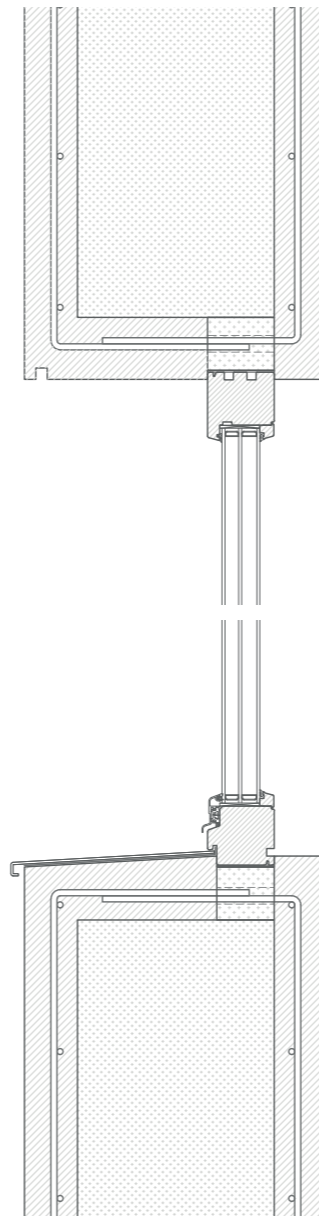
Detalle muro-ventana proyecto modificado E1:10
